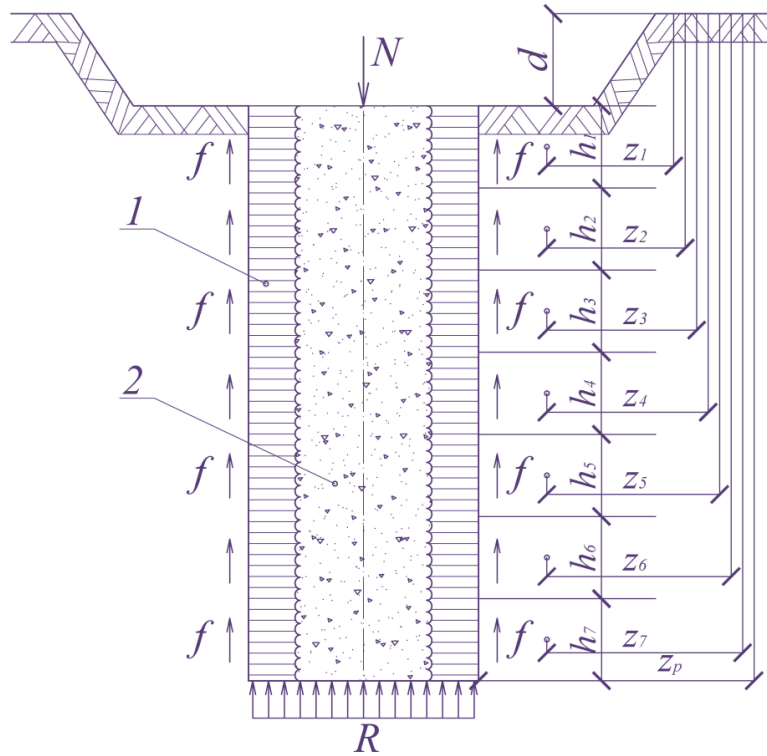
Схема к определению несущей способности сваи SFA (НПШ) совместно с грунтоцементным массивом по грунту (грунтобетонные сваи (ГБС)
